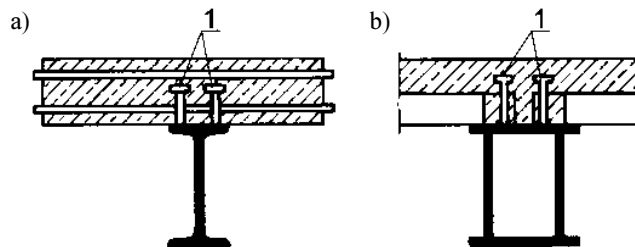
Strop płytowo-belkowy: 1 - belka stalowa (żebro), 2 - żelbetowa płyta stropowa
